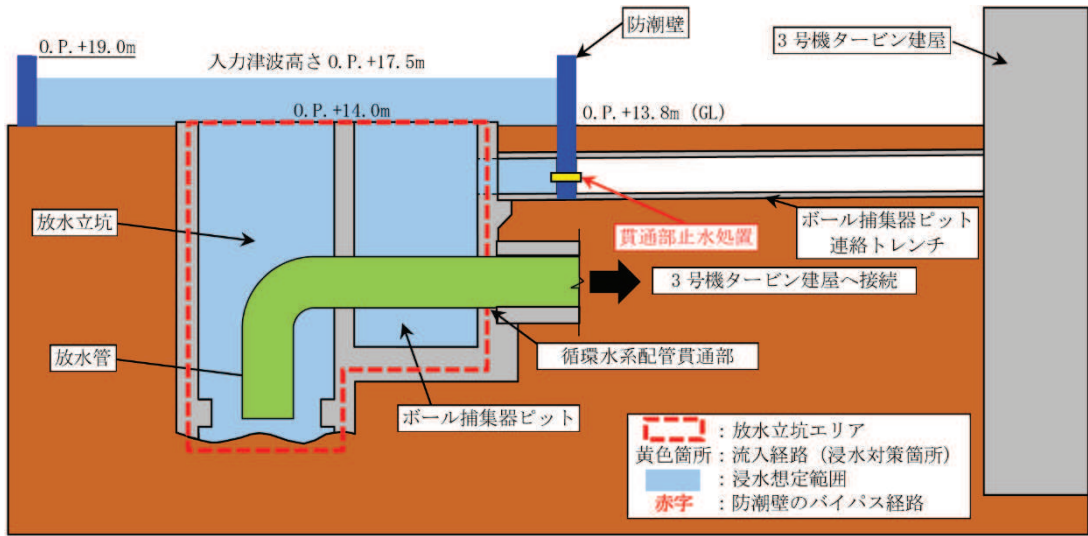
(16) 第 3 号機 放水立坑 流入対策配置図 (A-A 断面図)
